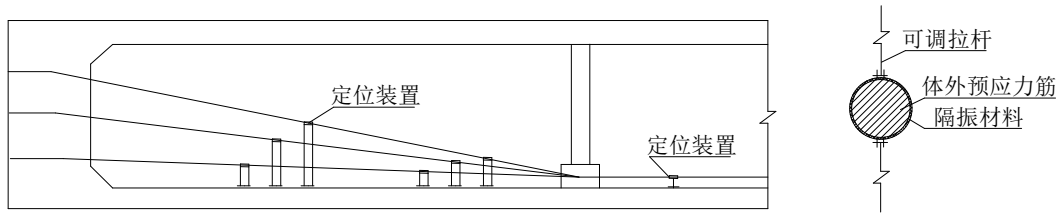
体外预应力的定位及减振装置构造示意图
